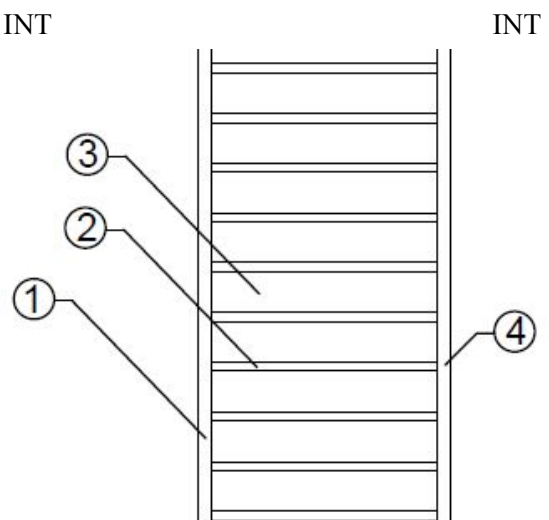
Sección muro tipo 2 (Fuente: Anejo A)
